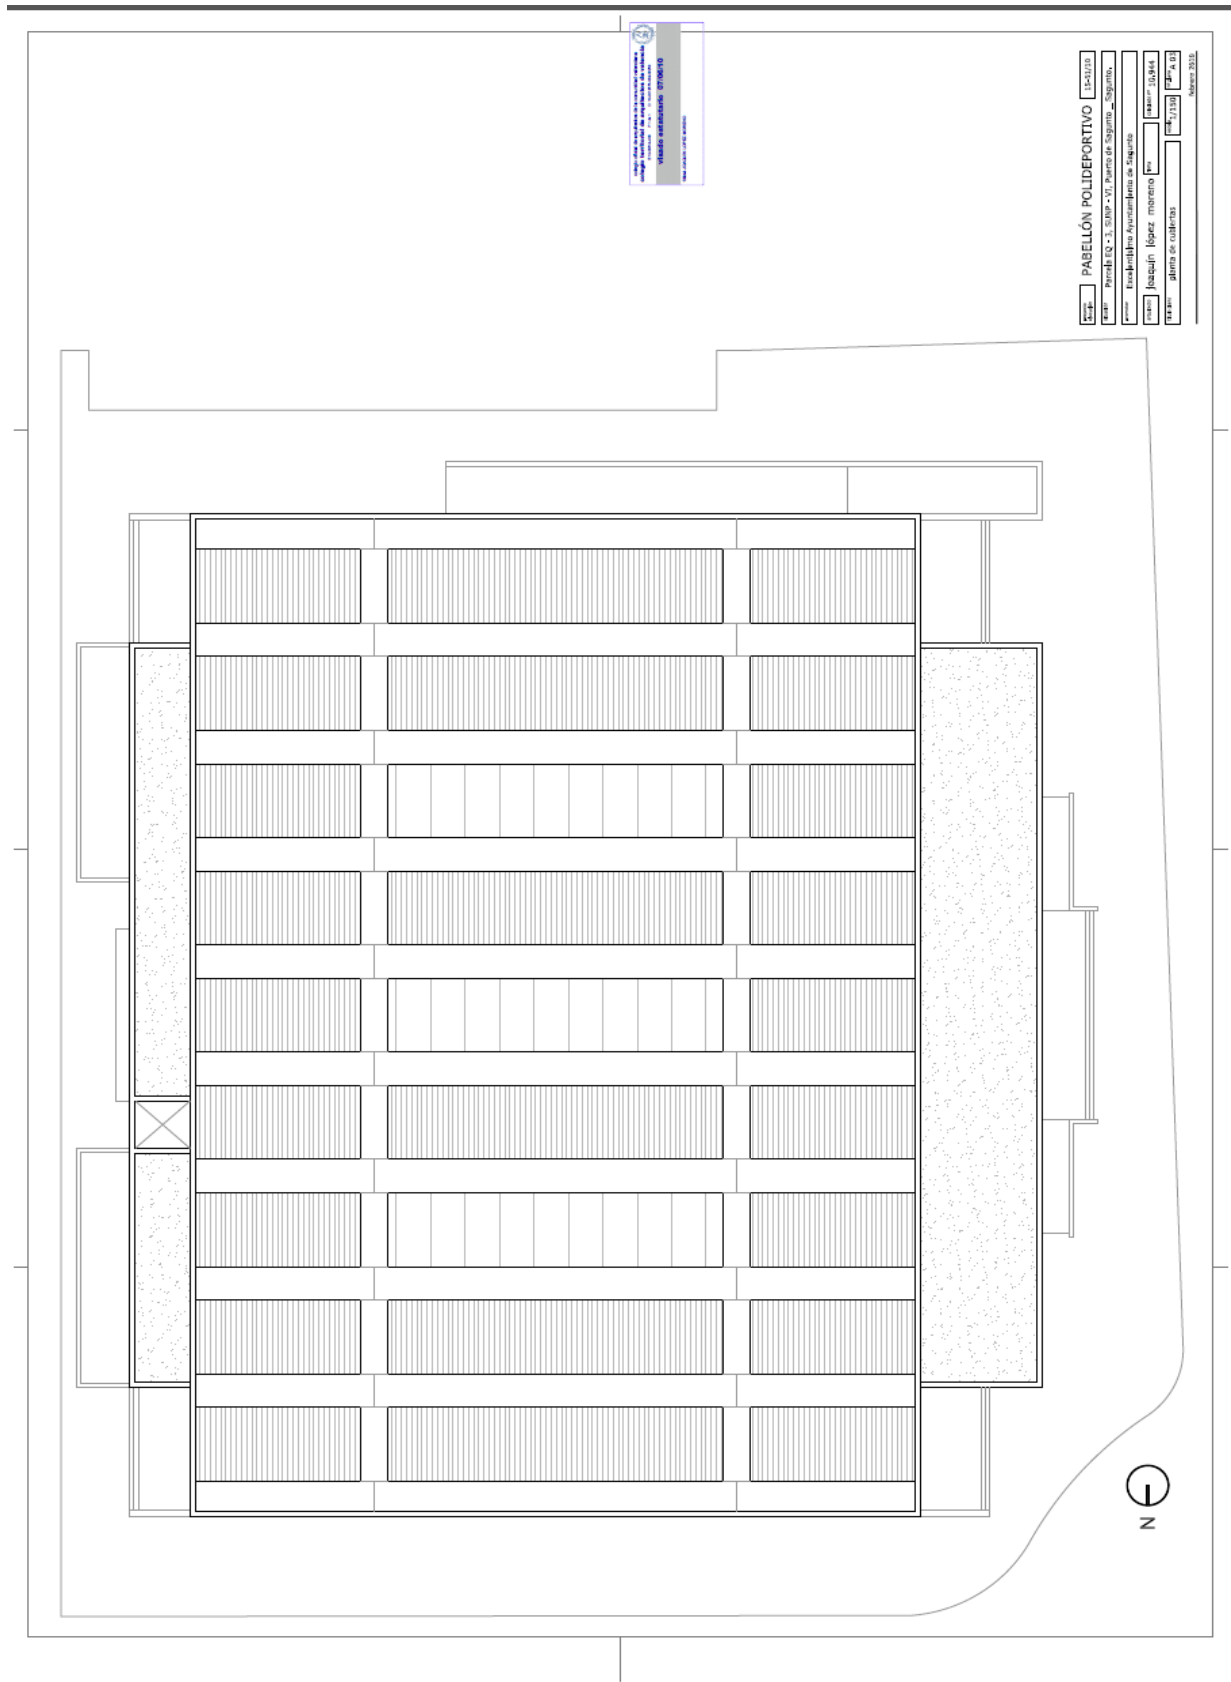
Plano cubierta Pabellón. Fuente: Proyecto de Ejecución.
